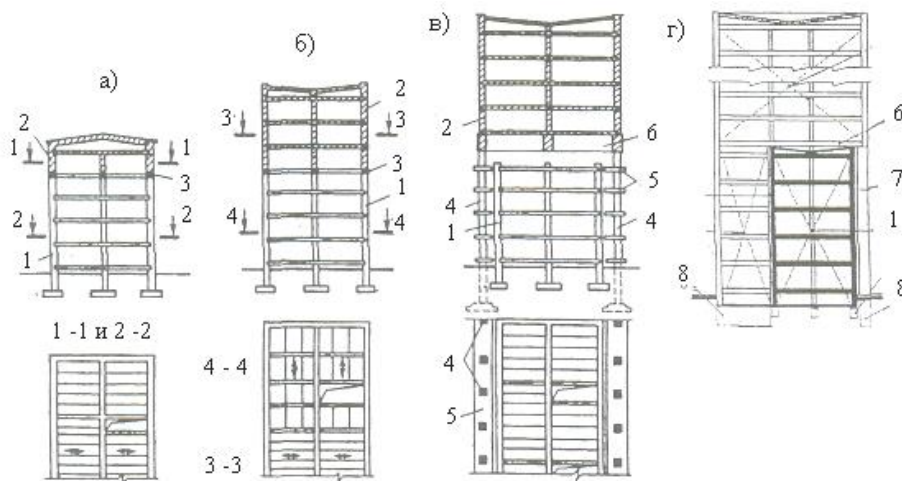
Конструктивные схемы надстроек зданий в плане и разрезе:
